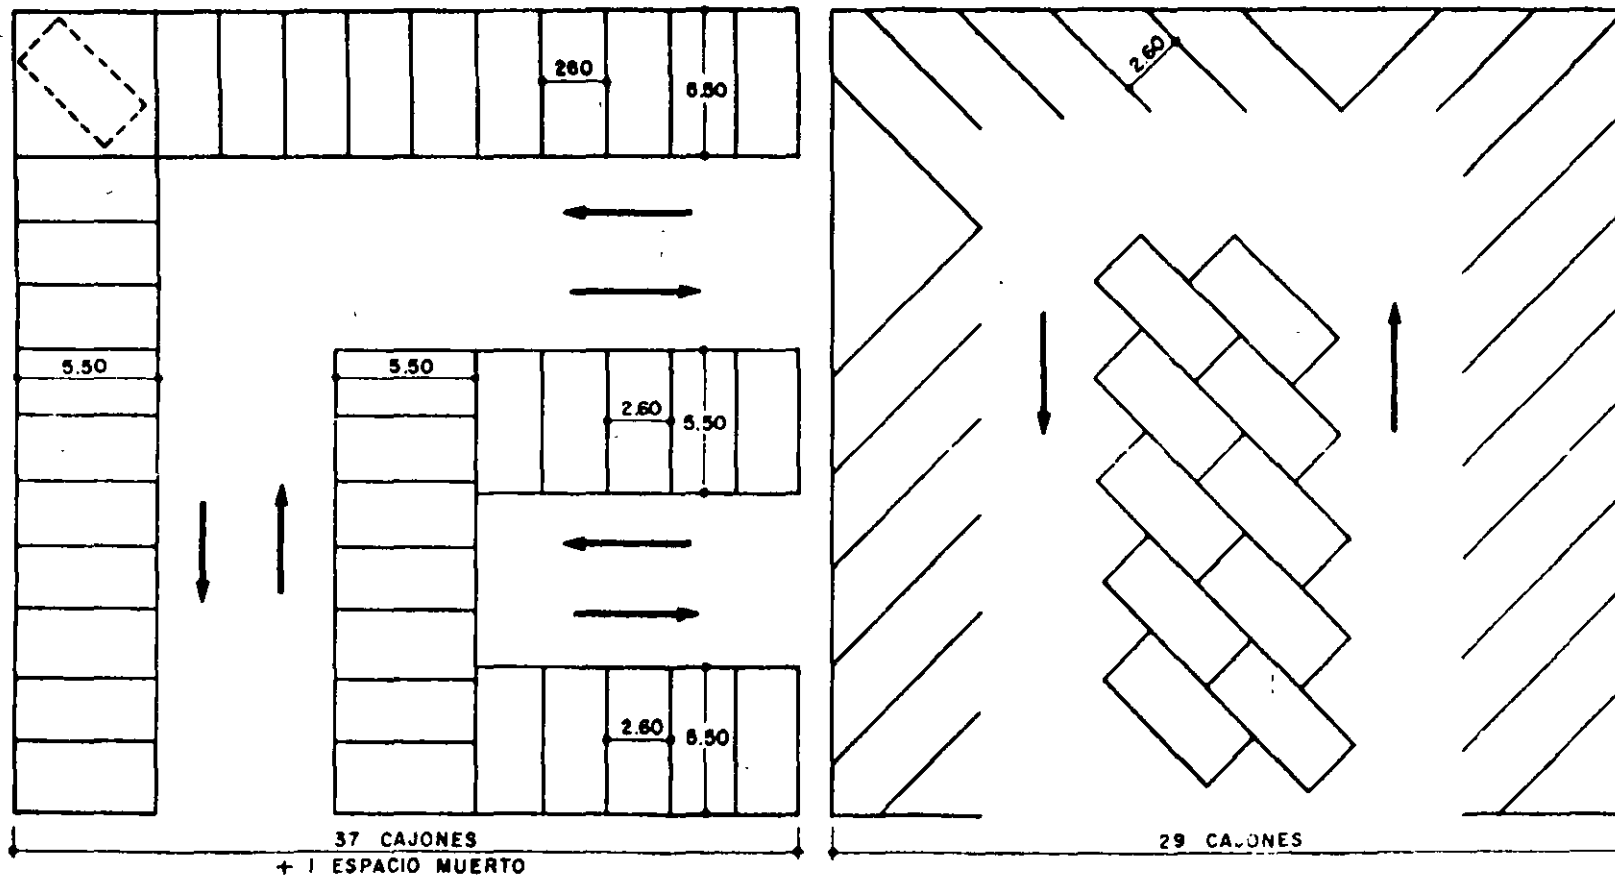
ALTERNATIVAS DE DISTRIBUCION PARA UN LOTE DETERMINADO
